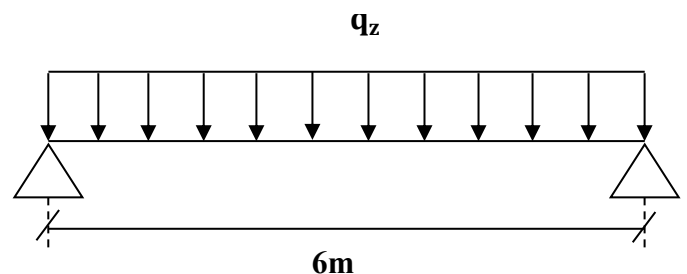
Actions sur la lisse de bardage dans le plan (Z-Z)
